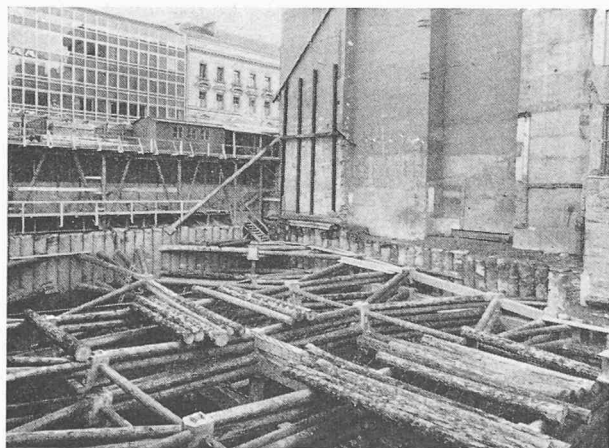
Fouille de l'Union de Banques Suisses (U.B.S.), à Zurich. Enceinte constituée par une paroi de pieux jointifs.
